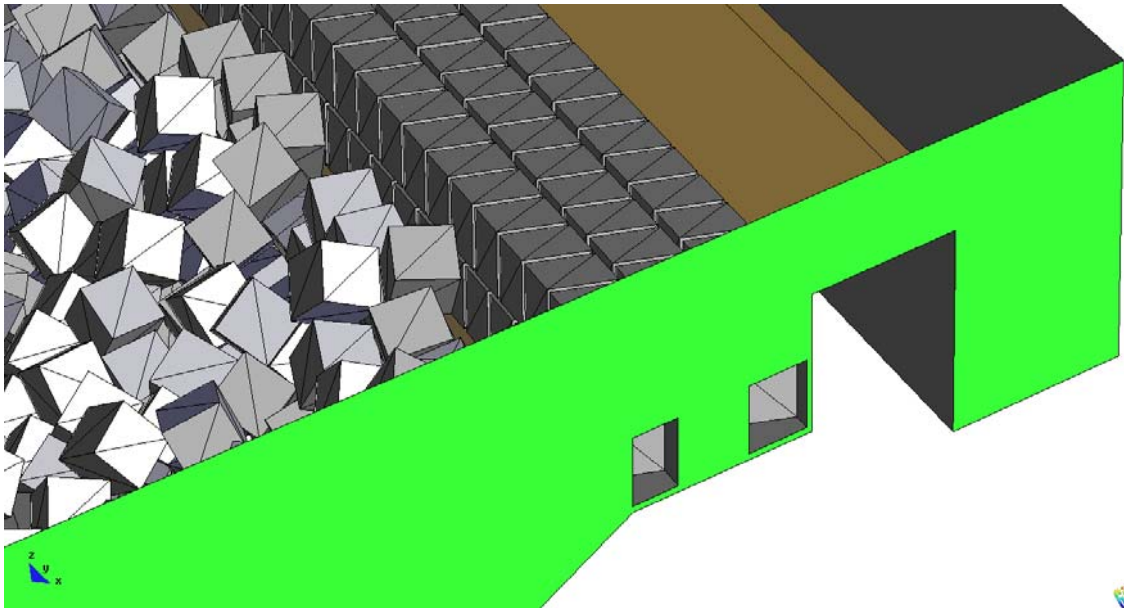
Detalle del corte entre las paredes y la superestructura.
